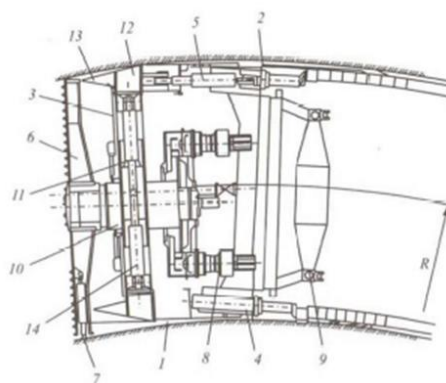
Конструктивная схема щитовой машины с шарнирным корпусом второго вида
